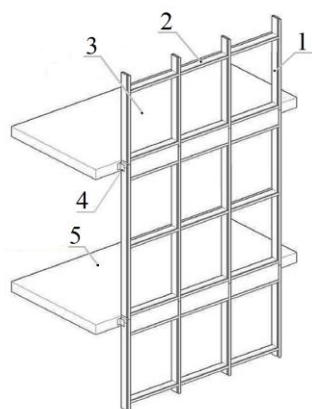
Схема стоечно-ригельной фасадной системы: 1 – стойка; 2 – ригель; 3 – заполнение; 4 – крепежный элемент; 5 – перекрытие
